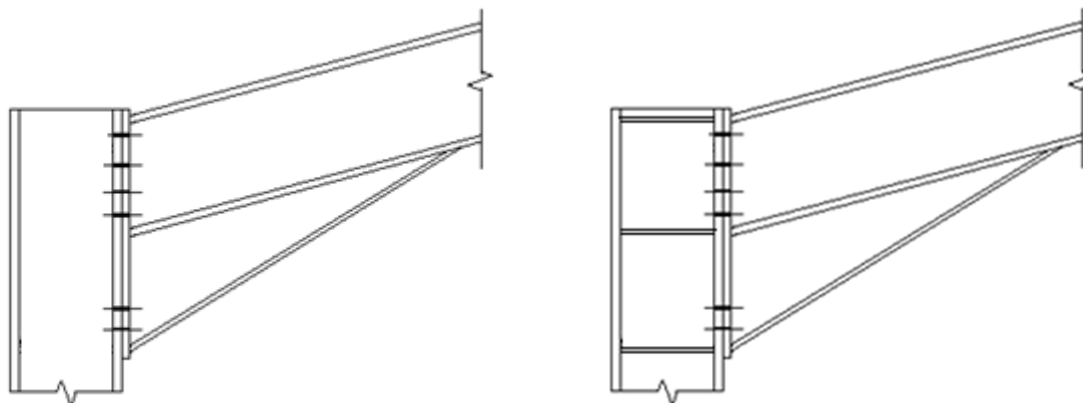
Ligação pilar-travessa com placas de extremidade
